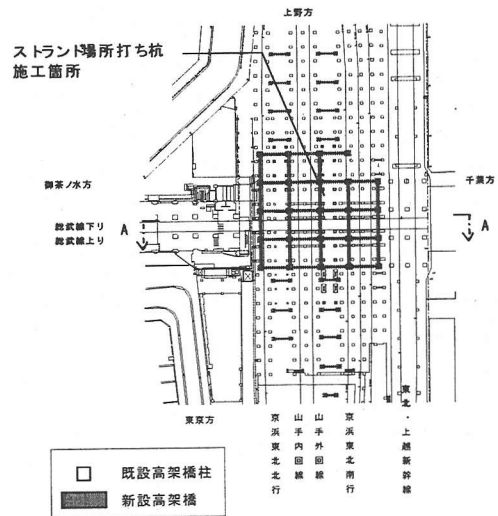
秋葉原駅ストランド場所打ち杭施工位置図
